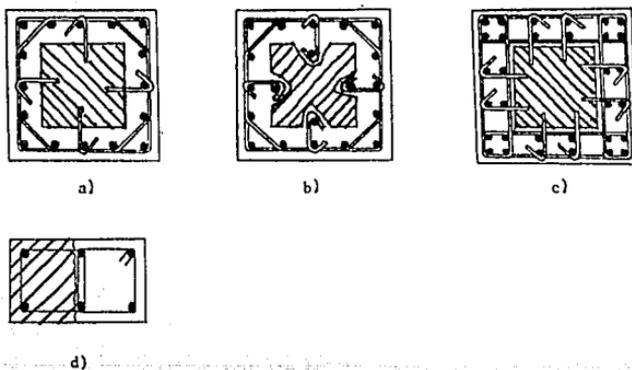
Detalle del refuerzo transversal para encamisado de columnas.
